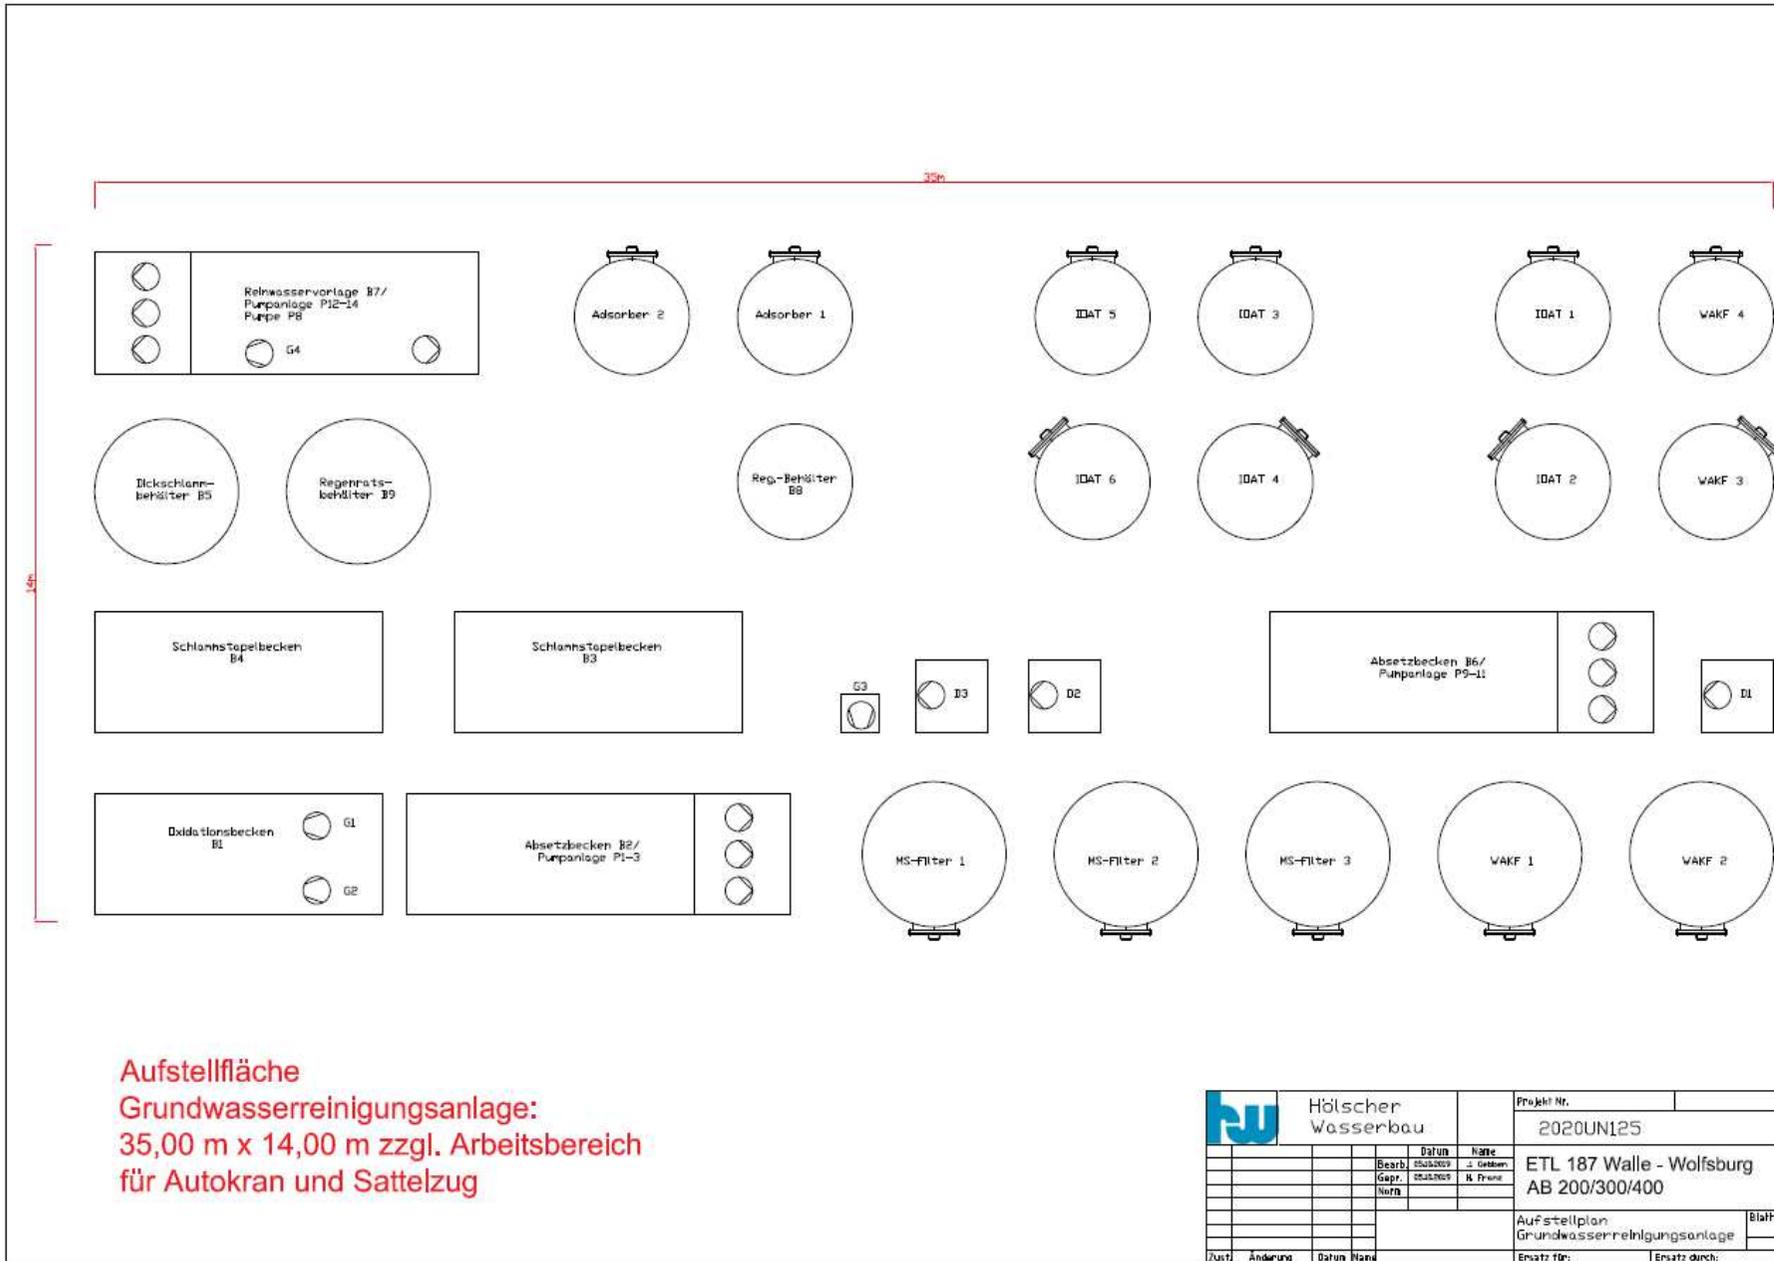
Aufstellplan Grundwasserreinigungsanlage
